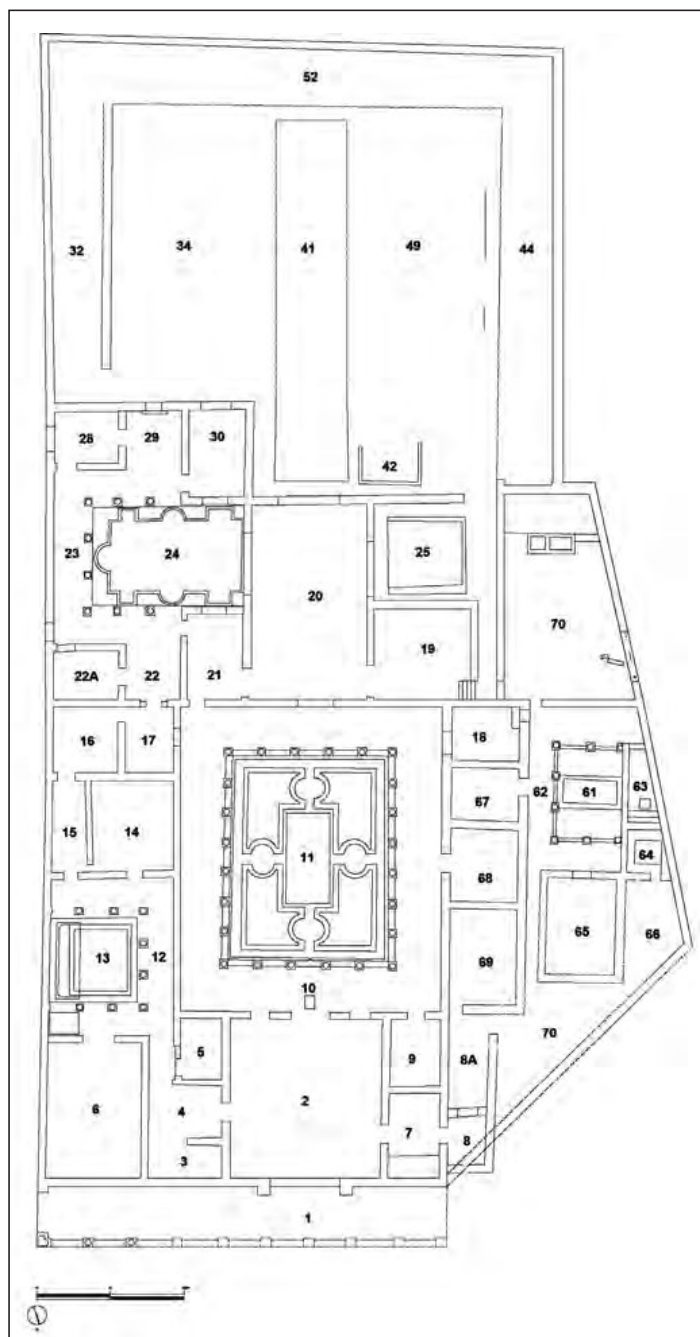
Casa atribuída a Cantaber: plano de conjunto da fase II. ©MMC/DGPC.
